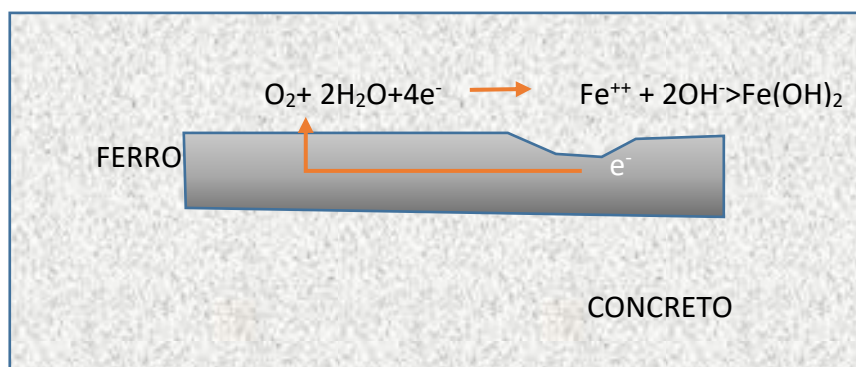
Corrosão na armadura do concreto
